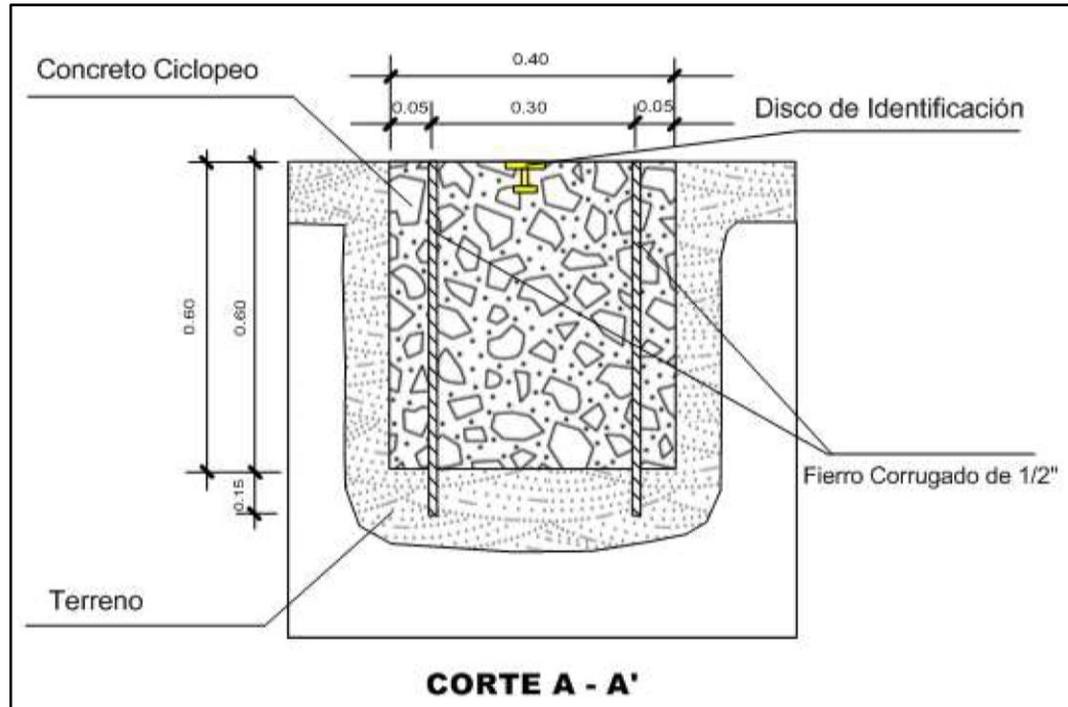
Esquema del pilar de concreto de los puntos geodésicos (vista en elevación)
